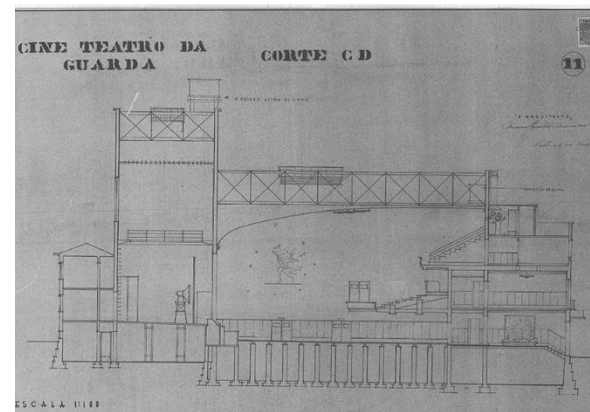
Cineteatro da Guarda Planta, Corte longitudinal
